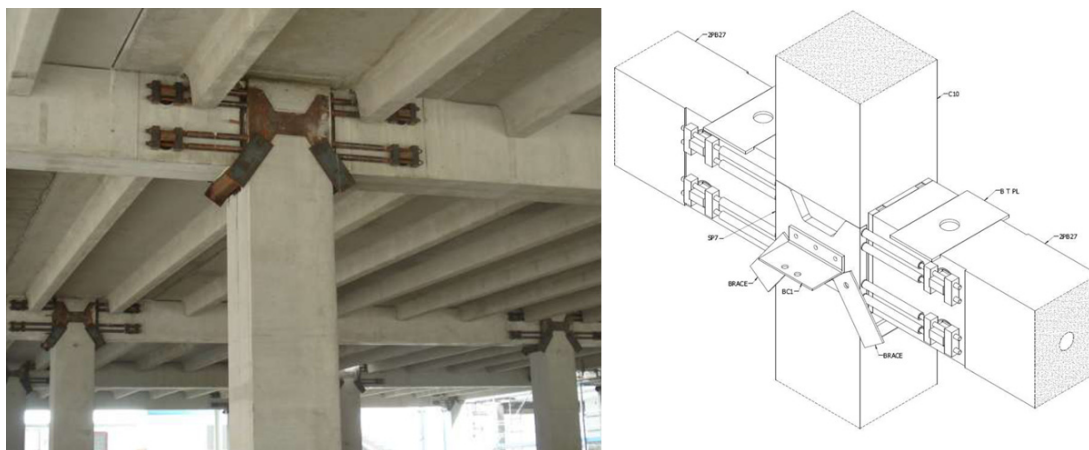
Ligação viga-pilar utilizada no primeiro “PRESSS Building” construído na Nova Zelândia (Pampanin, 2011)
